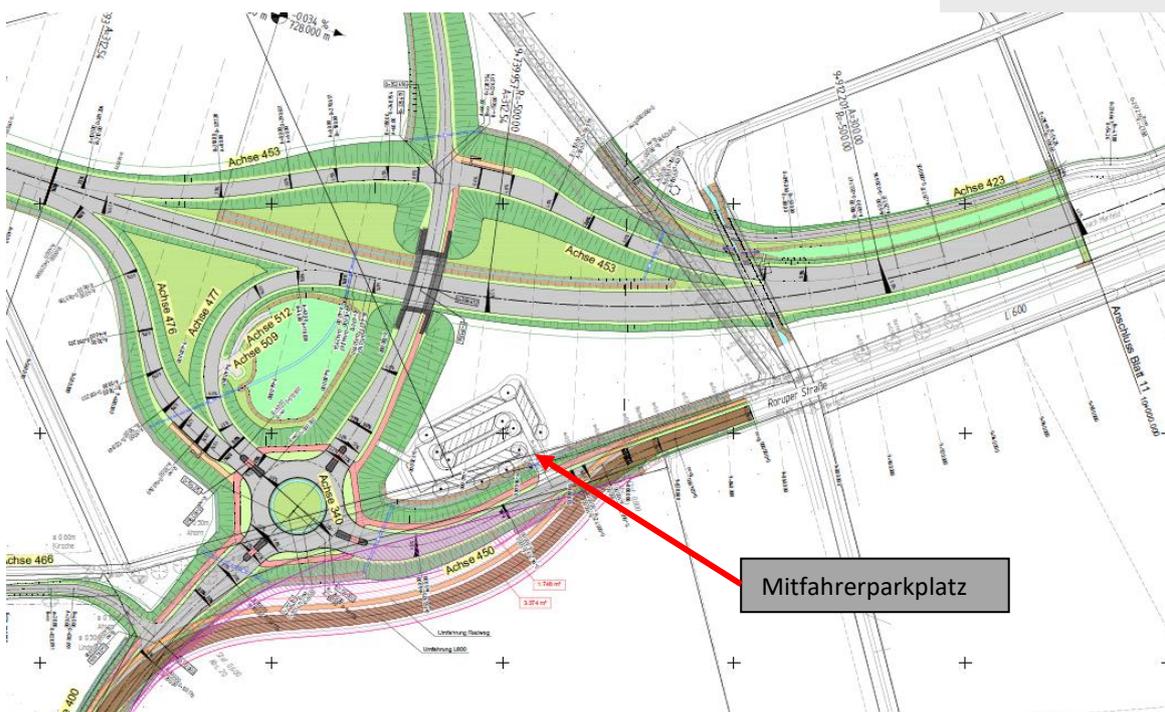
Lageplan zu B 67n einschließlich Mitfahrerparkplatz
